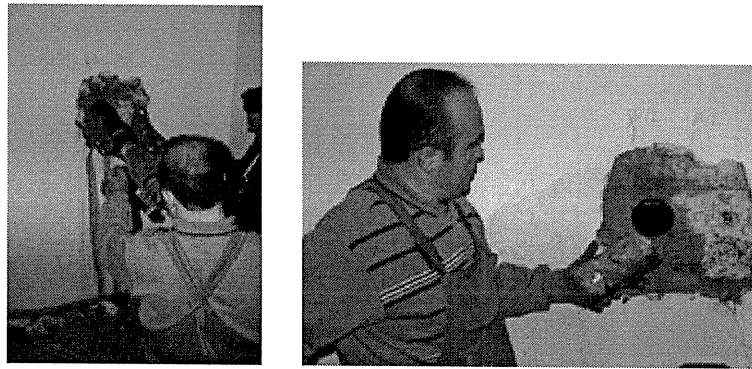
Zemin kat betonarme perdede donatı tespiti
